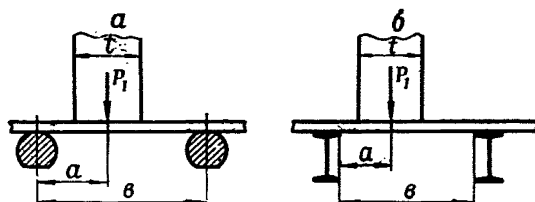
Расчетные схемы поперечного настила при расположении колеса не посередине расстояния между прогонами:
